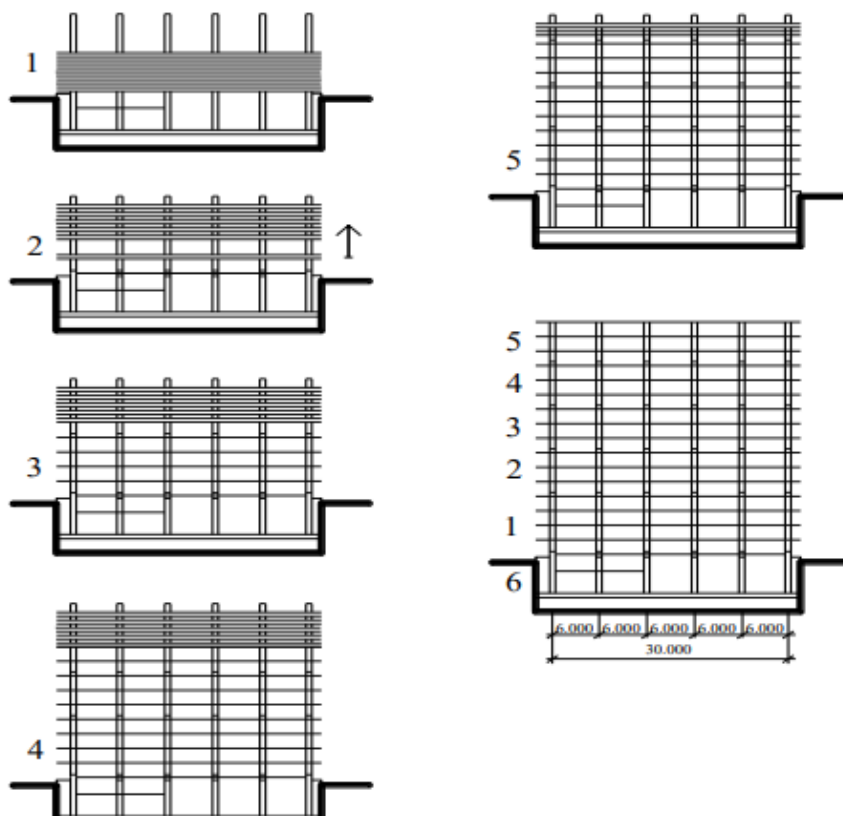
Схема монтажу будинку методом підйому перекриттів: 1 – монтаж колон, сходиново-ліфтової шахти, бетонування пакету перекриттів, 2-6 – підйом перекриттів на колони ярусу та закріплення чергового перекриття на проектній відмітці
